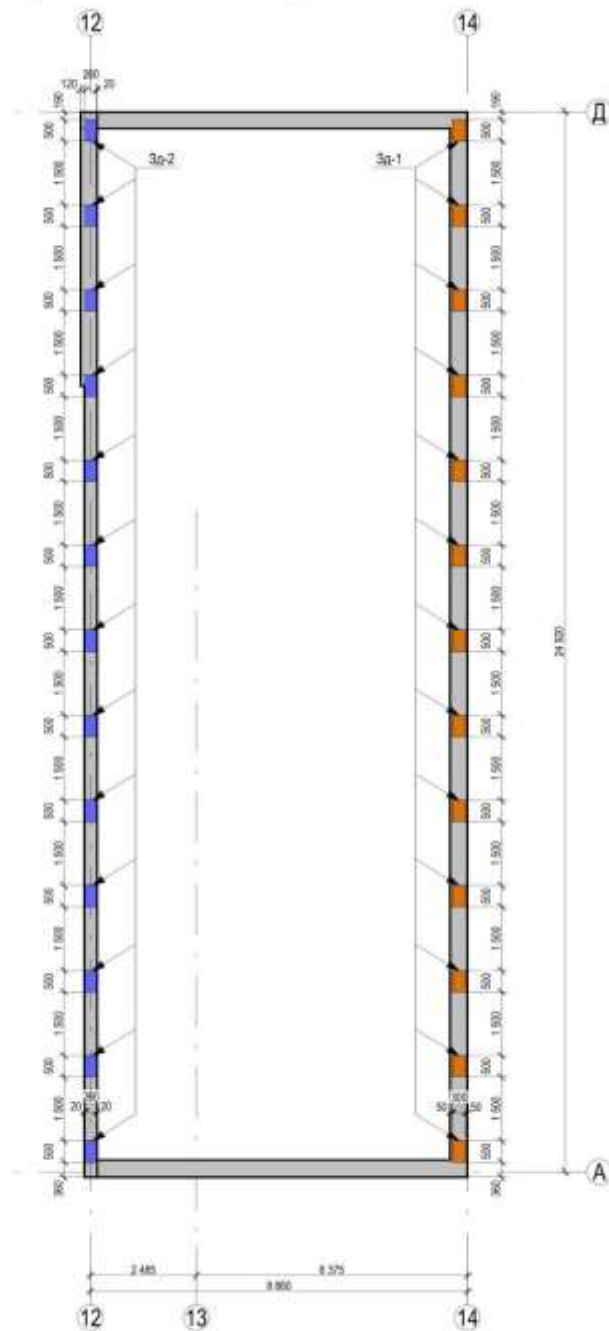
Схема розташування закладних в армопоясі на відмітці
